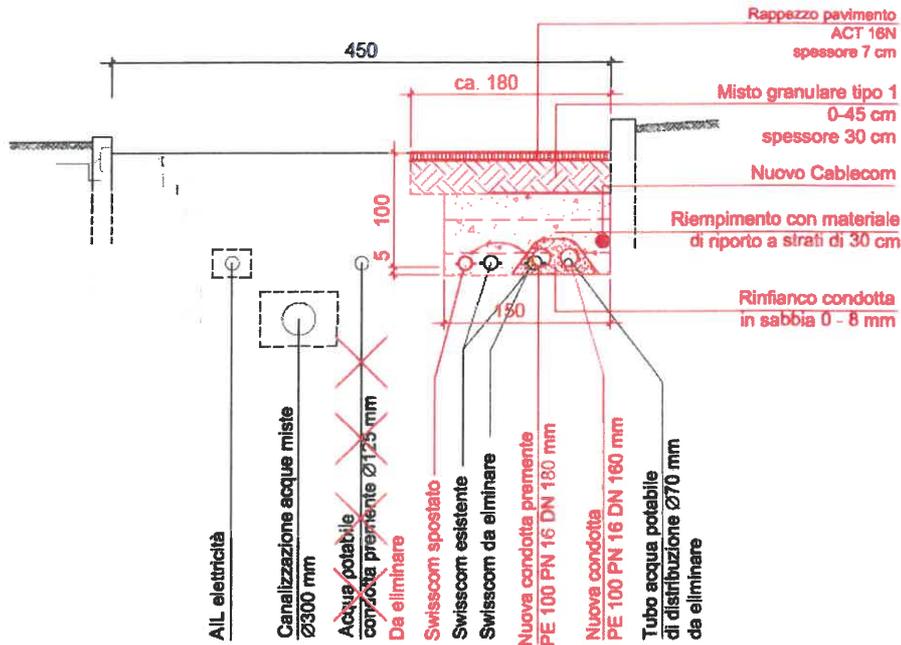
Sezione tipo lungo la strada ara Morèla verso la Via ai Romani (sezione con posa del tubo per la zona alta + tubo nuovo premente)
